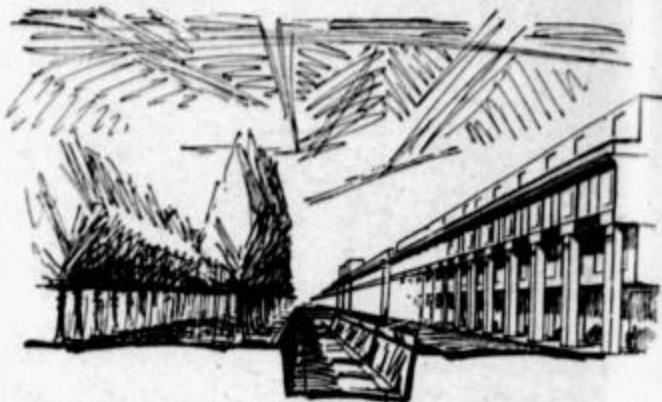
Autostraße im Einschnitt und eingebaute Kolonnaden. Aus dem Entwurf „Neues Ortogesetz“.
